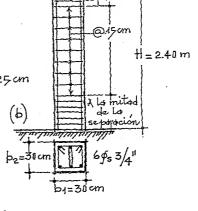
Colococión del acero vertical y separación de estribos en la columna, (b).
